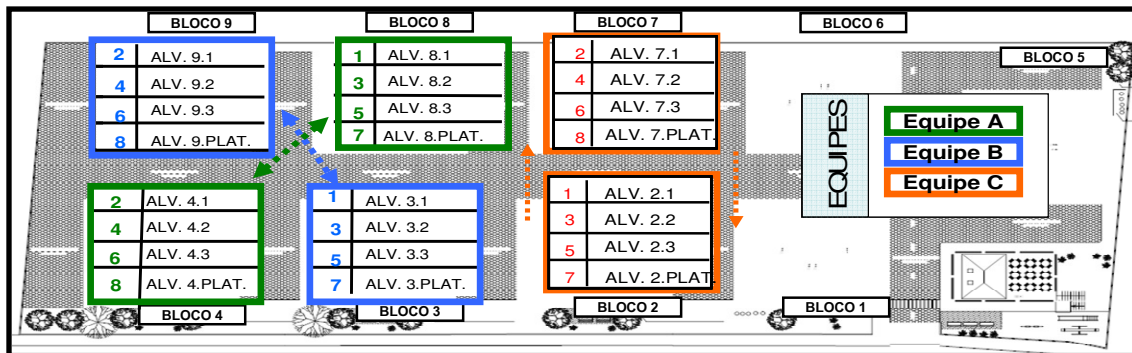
Novo plano de ataque para alvenaria de blocos de concreto – Tático 2
